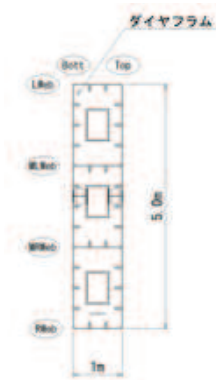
(2) 鋼製遮水壁（鋼桁 5） 平面図
